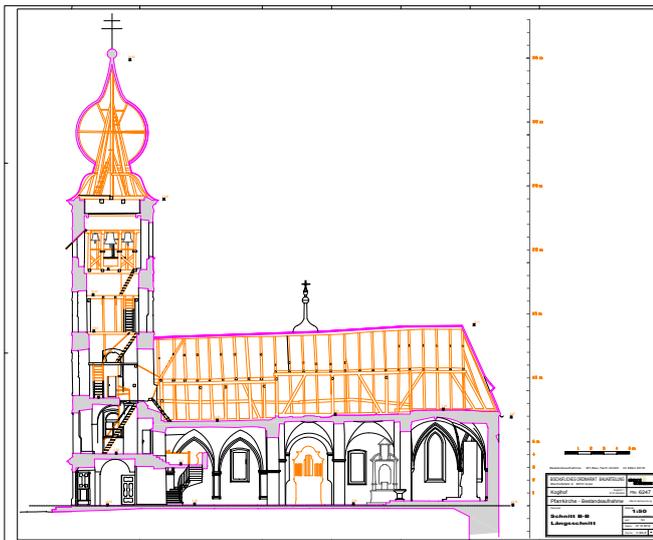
Pfarrkirche Koglhof – Plan Längsschnitt B-B
